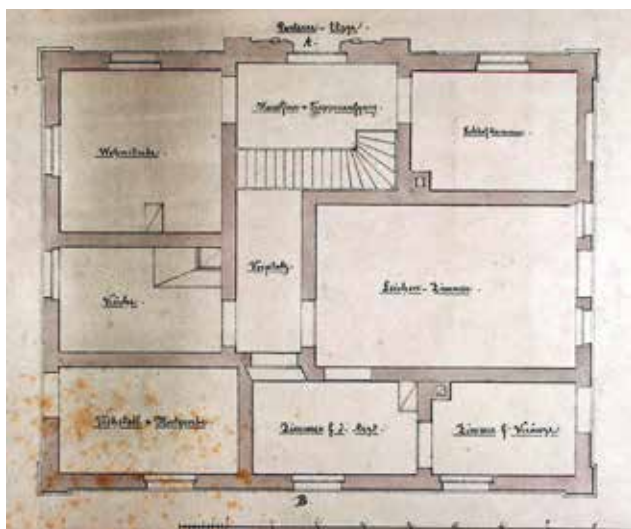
Grundriss des Erdgeschosses des Hildesheimer Leichenhauses, nach 1860. (StadtA HI Best. 950 Nr. 1970)
